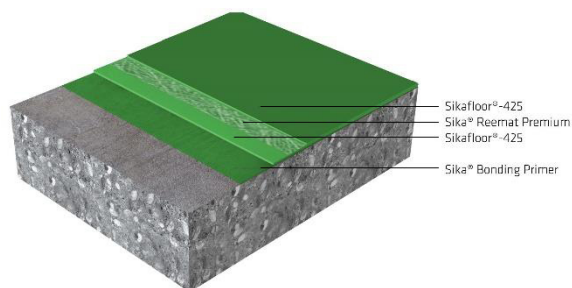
SIKAFLOOR®-425 Système d'étanchéité à l'eau
